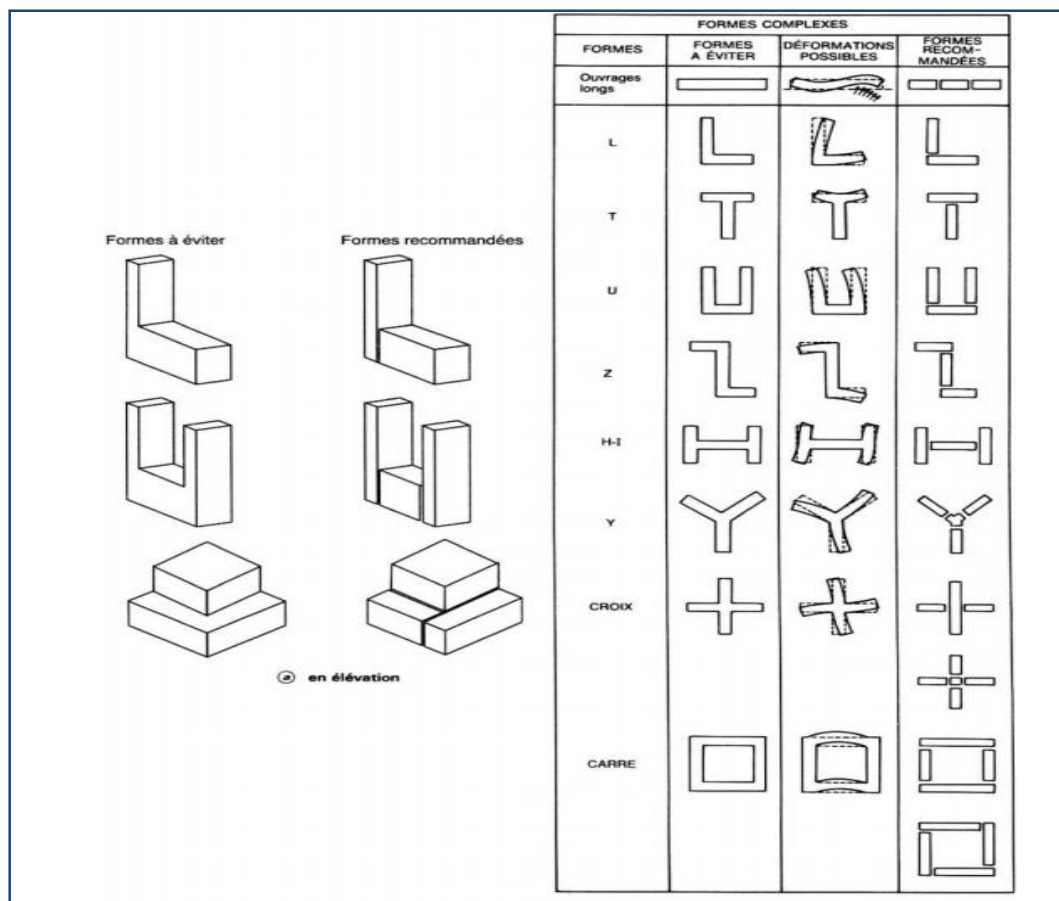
Sous structuration par joint pour garantir la régularité en plan
